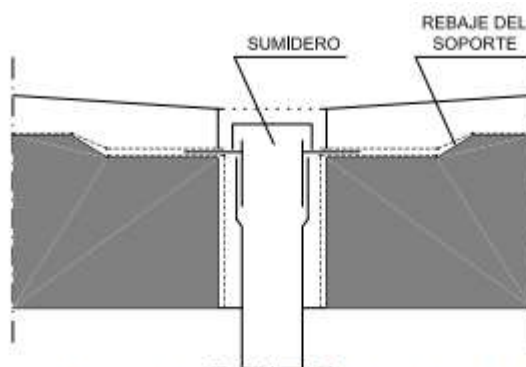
Rebaje del soporte alrededor de los sumideros
